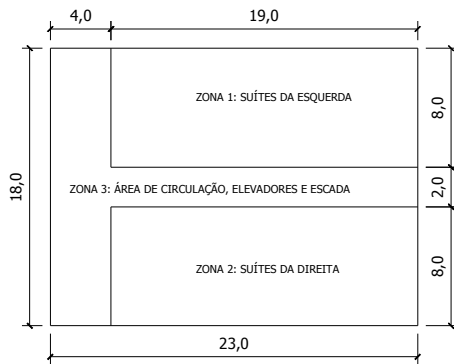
Divisão do pavimento tipo em 3 zonas térmicas.
